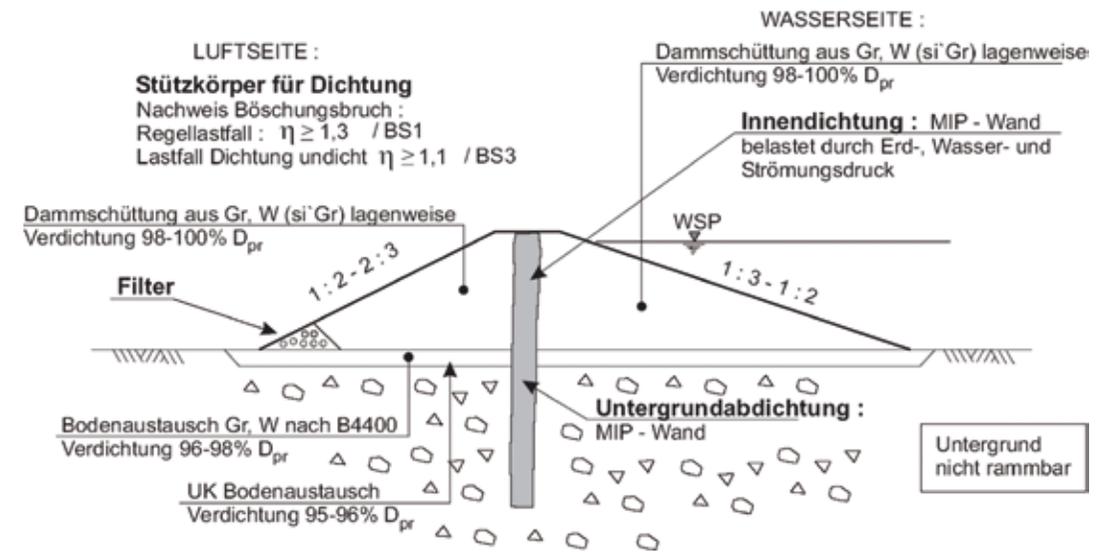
Bautyp – Damm und Untergrundabdichtung bei nicht rammbarem Untergrund mit „Mixed-in-Place“-Wand (MIP)
